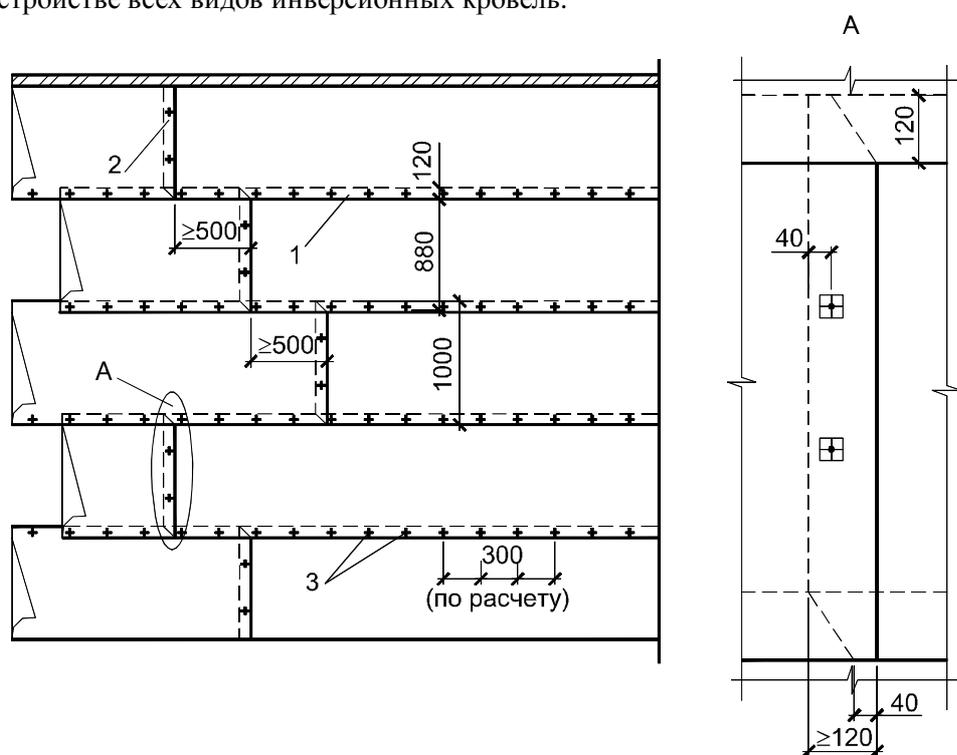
Схема раскладки рулонных материалов однослойной кровли и их закрепления при уклоне по ендове не менее 2,5 %
